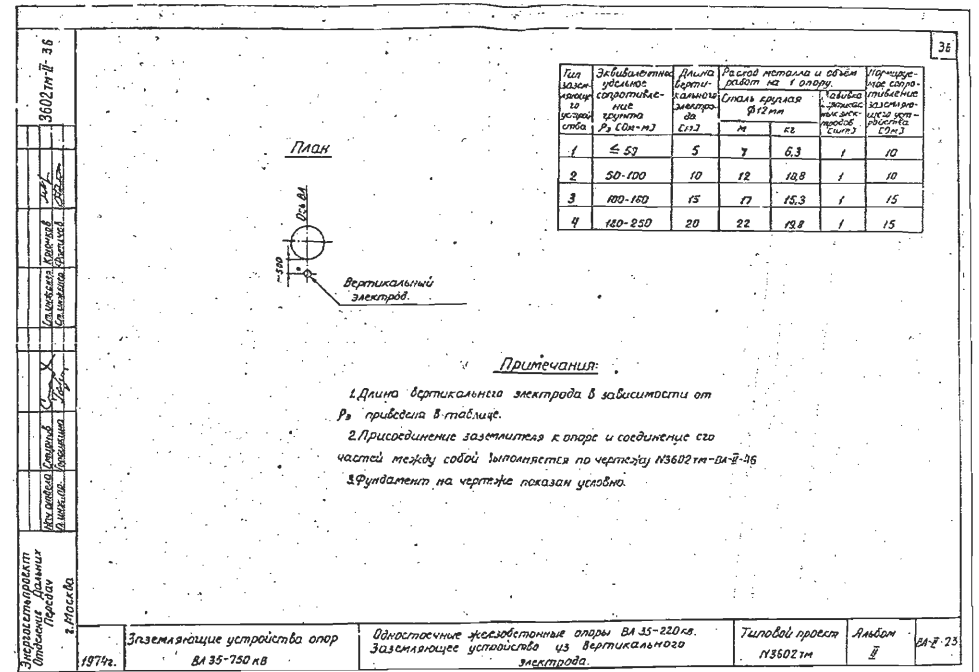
Схема установки заземлителя (чертеж № 3602тм-ВЛ-II-23).
